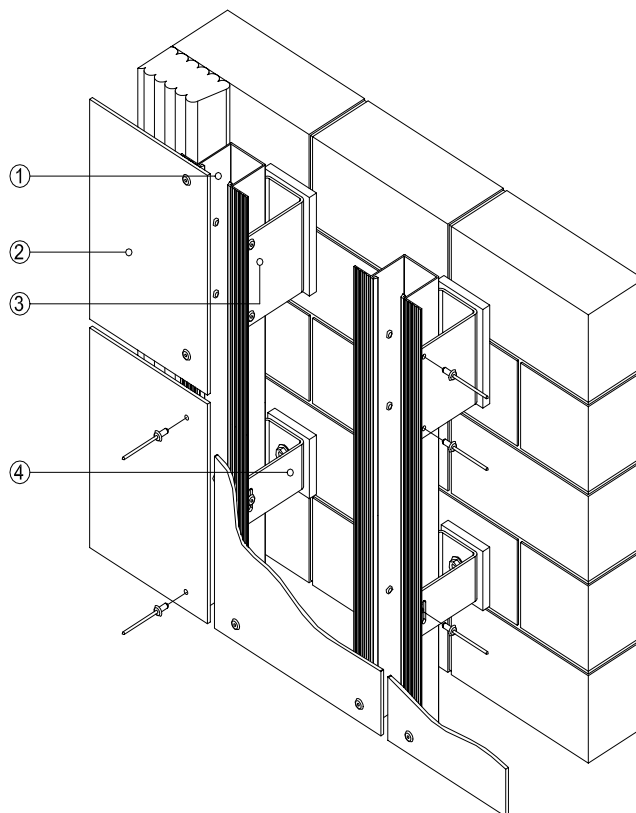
Revestimiento de fachadas ventiladas a base de placas remachadas sobre subestructura unidireccional
